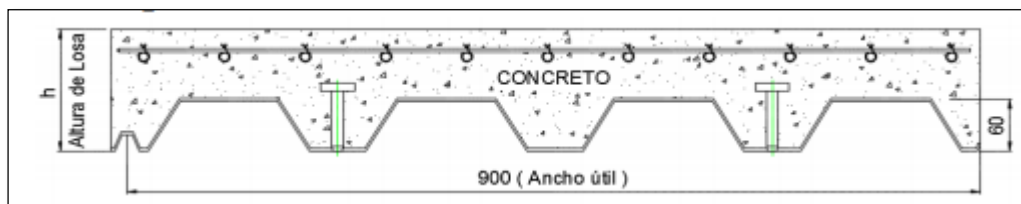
Perfil de losa Colaborante, por "Distribución y construcción Codrysac".
